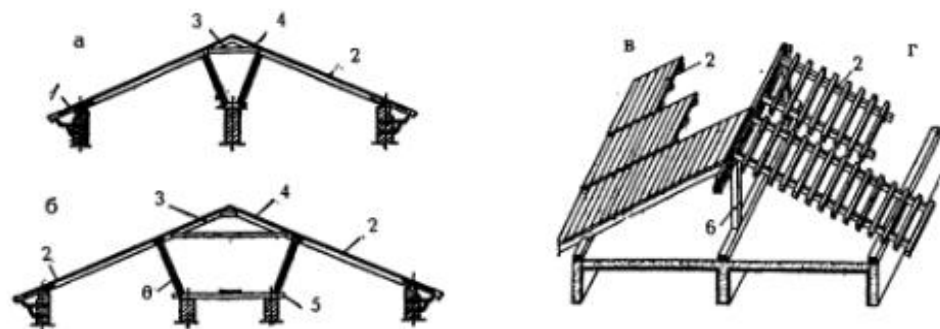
Схемы и общий вид индустриальной конструкции наслонных стропил: а – для зданий с одной внутренней стеной; б – то же, с двумя; в – общий вид конструкции при стропильных щитах со сплошной дощатой обрешеткой; г – то же, с разреженной из брусков; 1 – карнизный щит; 2 – стропильный щит; 3 – стропильная фермочка; 4 – верхний щит; 5 – опорный брус; 6 – продольная рама
